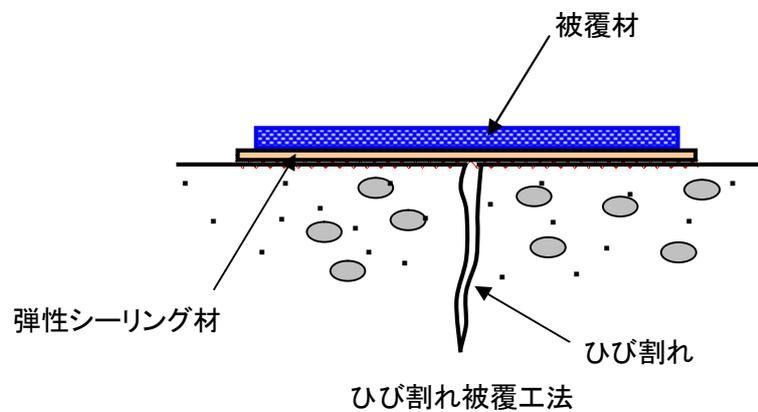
一般的なひび割れ被覆工法の概要図
